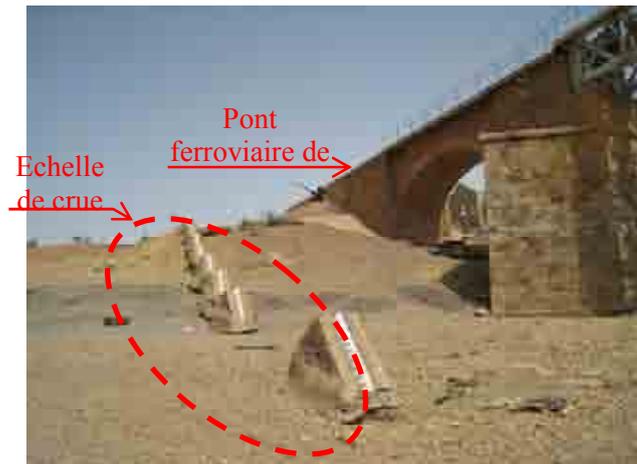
Echelle (et Pont ferroviaire à droite)
